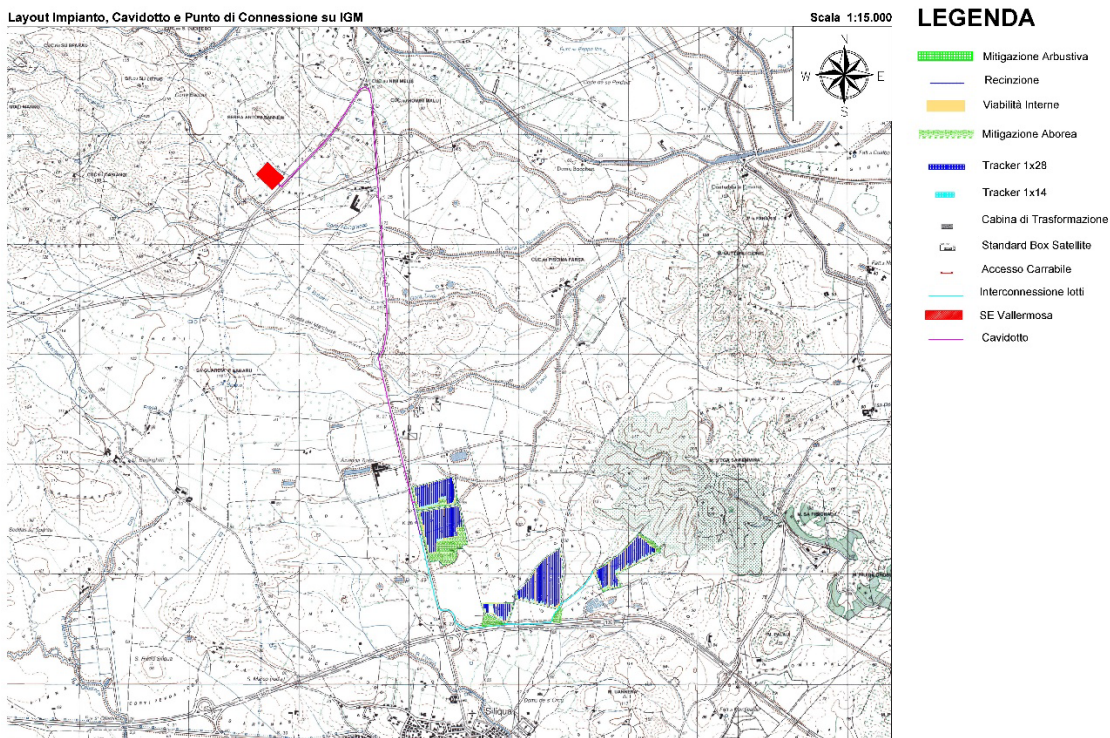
Layout Impianto e Cavidotto su I.G.M. del futuro impianto FV_SILQUA
